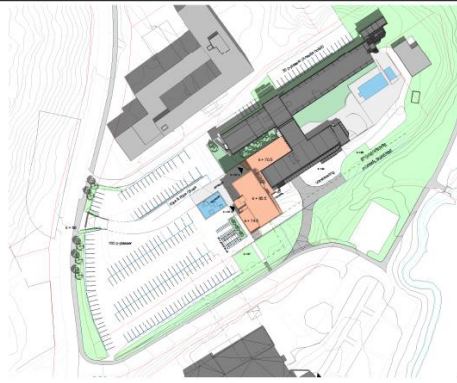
Utklipp fra utomhusplan med eksisterende bebyggelse i mørk grå og planlagt bebyggelse i rosa
